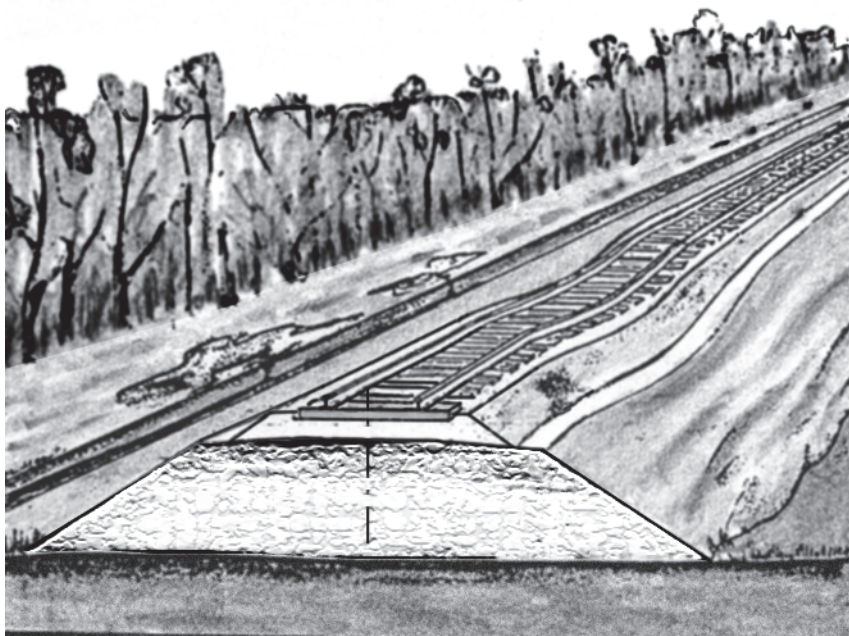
Оседания (осадки) основания и насыпи, возможно с выпиранием основания, в весенний период
